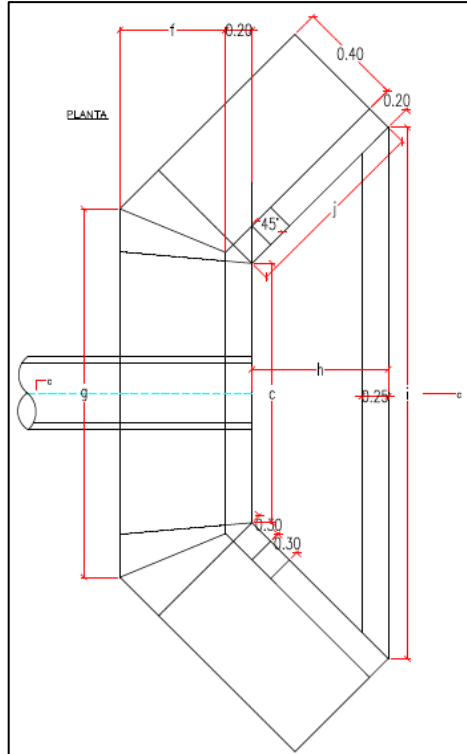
Planta de las estructuras hidráulicas a construir en el proyecto de Rionegro-Santander
